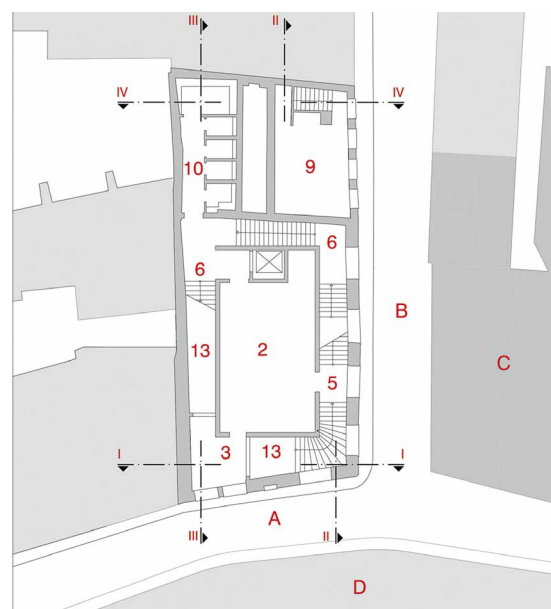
Museum; Grundriss 1. OG [© Konermann Siegmund Architekten BDA Stadtplaner]
